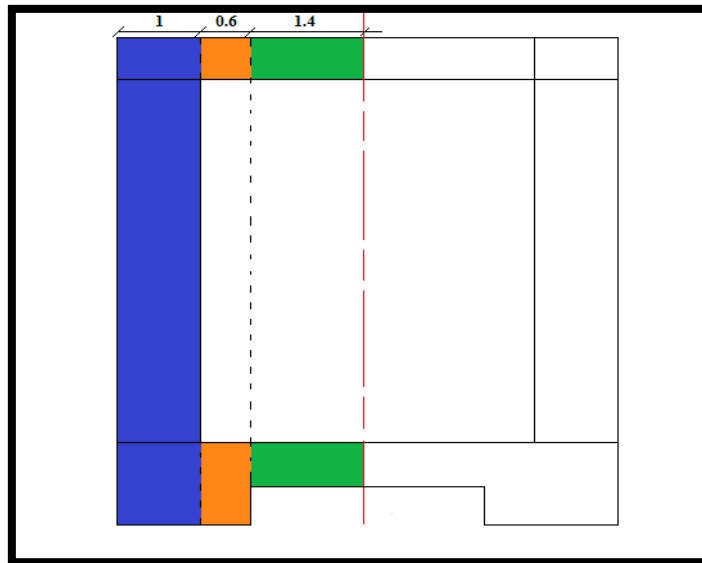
Coupe longitudinale du voussoir sur pile.
